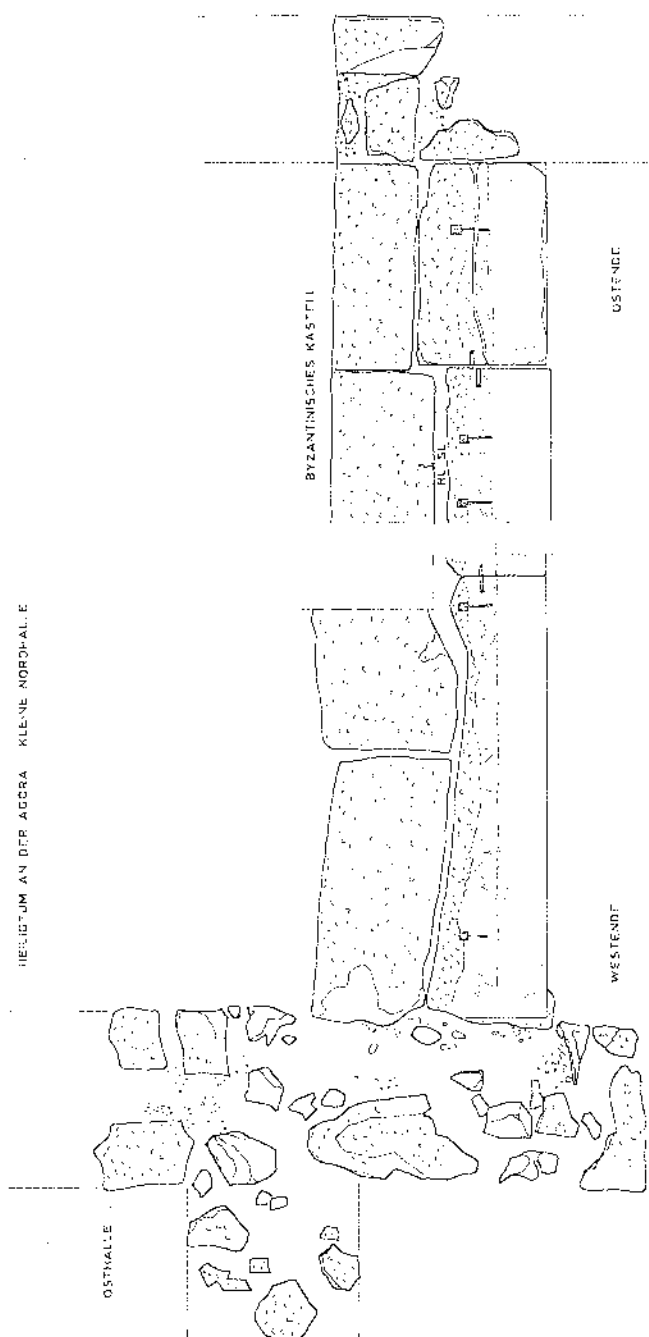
Prione, Asklepieion. Steinplan der Halle (Ausschnitt)
